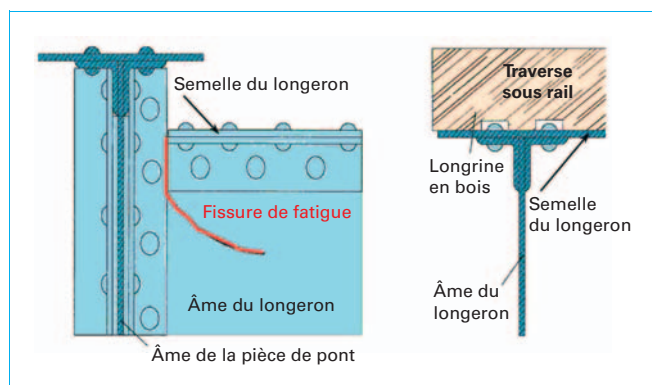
Fissure de fatigue dans un assemblage soudé pièce de pont-longeron
